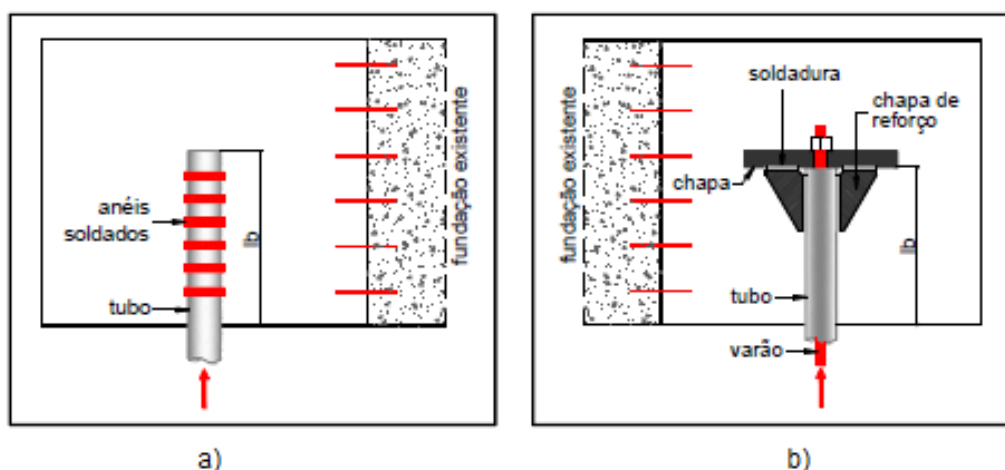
Ligação de microestacas com armaduras tubulares: a) Ligação com amarração direta; b) Ligação com dispositivos especiais[15]
